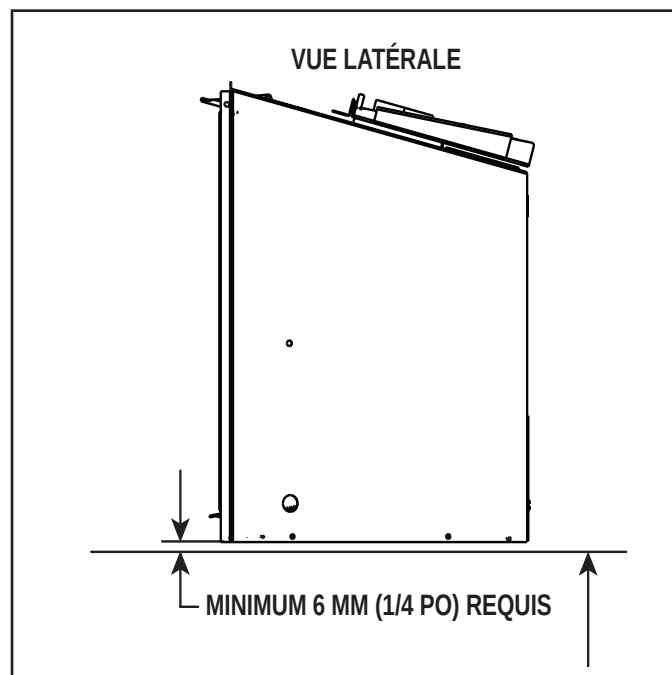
Dégagement par rapport au sol pour combustible solide
